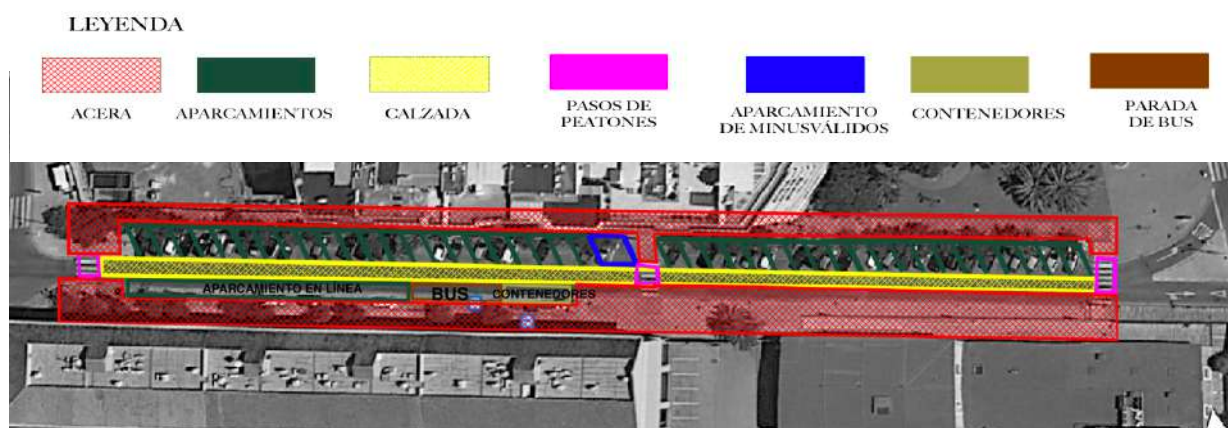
Modificación 3 para llevar a cabo sobre imagen de la calle. Fuente: Elaboración propia.
